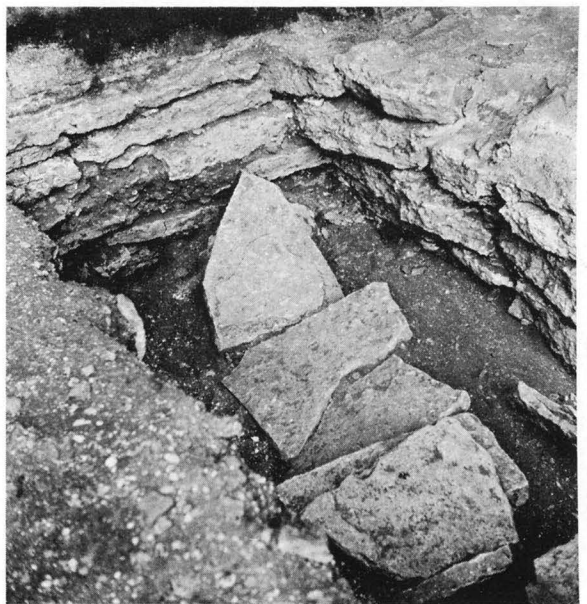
Hörn mellan grunderna till östra och södra muren i ej utförda koret. Foto W Falck 1972.
